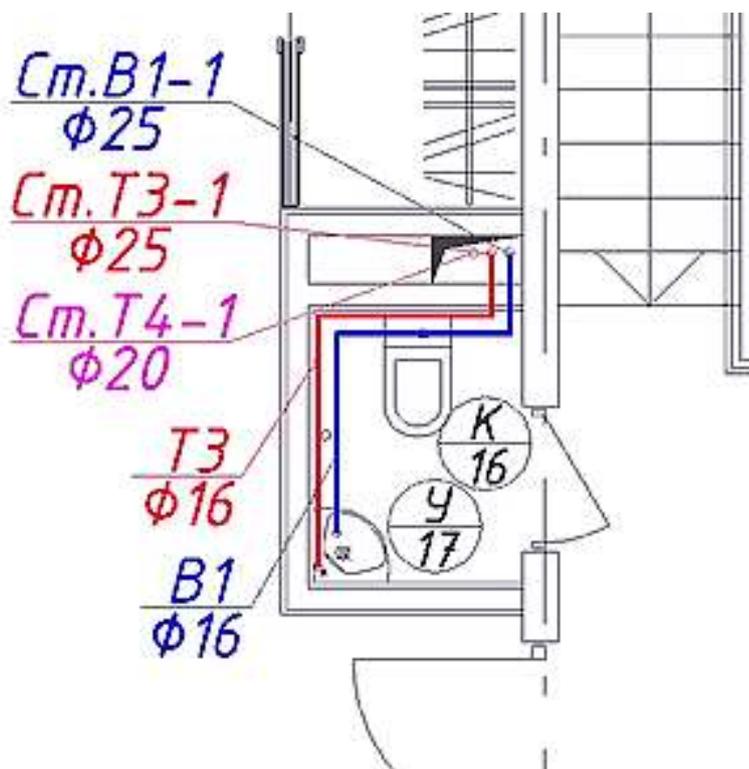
Пример фрагмента плана этажа со схемой системы водоснабжения
